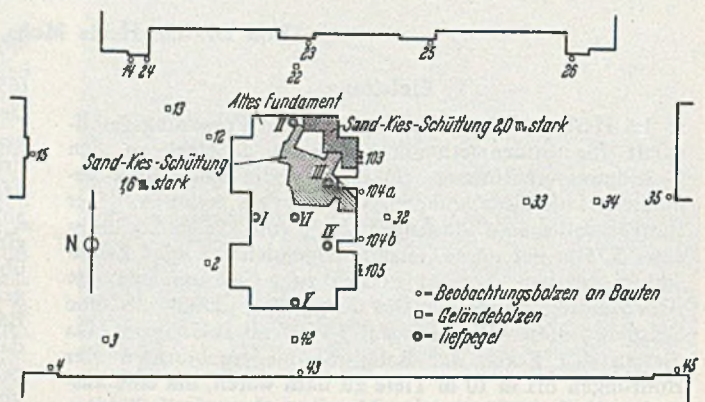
Lageplan des Bauwerkes und der Meßpunkte.
